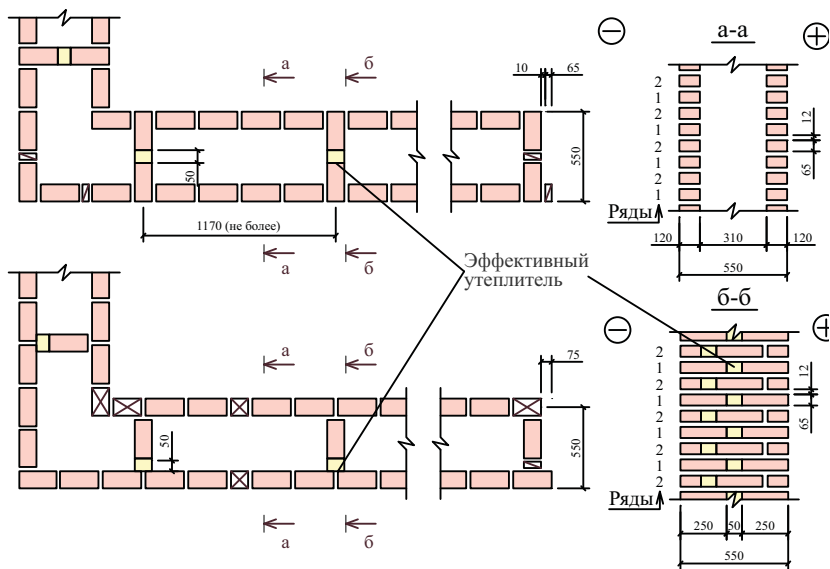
Наружная стена из кирпичной кладки с вертикальными кирпичными диафрагмами с самонесущим внутренним слоем (тип КД-1), толщиной 55 см. Сечение 18-18
